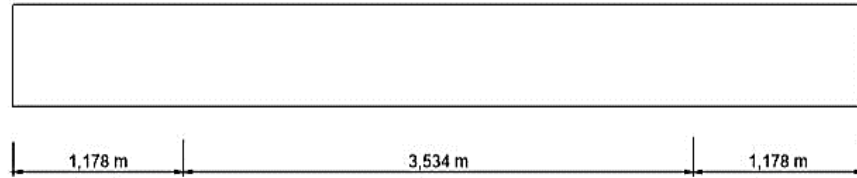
Viga en elevación con tramo 1 de 1,178 m y tramo 2 de 3,534 m.
